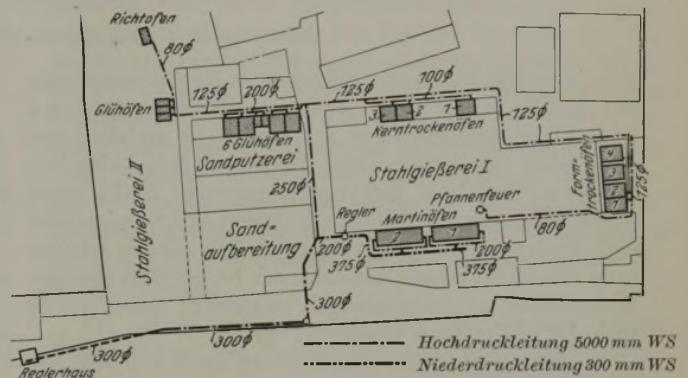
Lageplan der Oefen und Gasleitungen.
